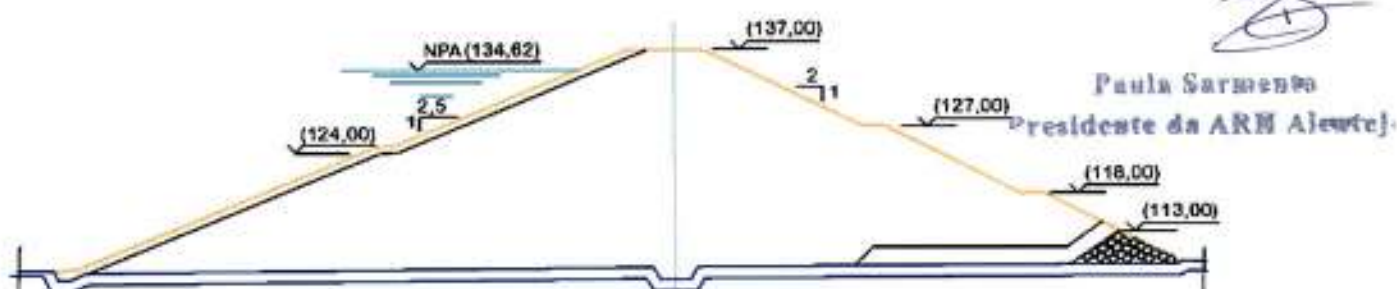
Perfil transversal da barragem do Corte Brique (Fonte: portal INAG – Barragens de Portugal)
